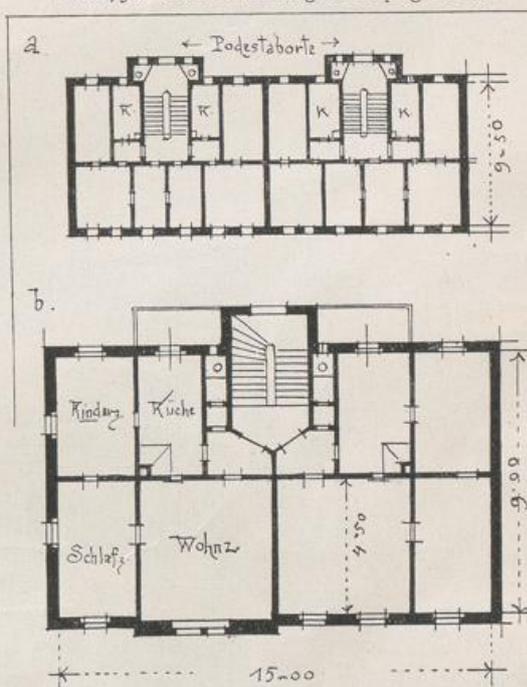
Wohnung für Eisenbahnbedienstete in Stuttgart.
